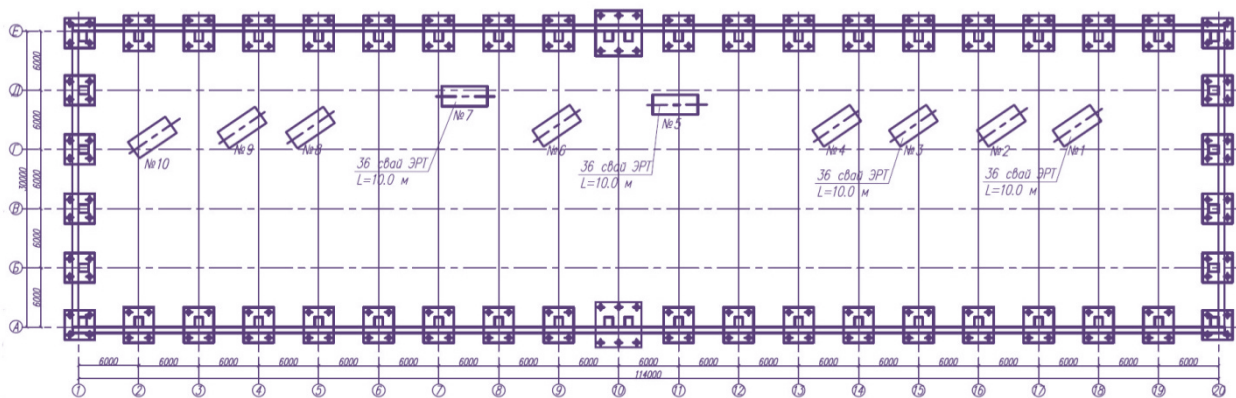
План свайного поля из буронабивных свай ЭРТ
